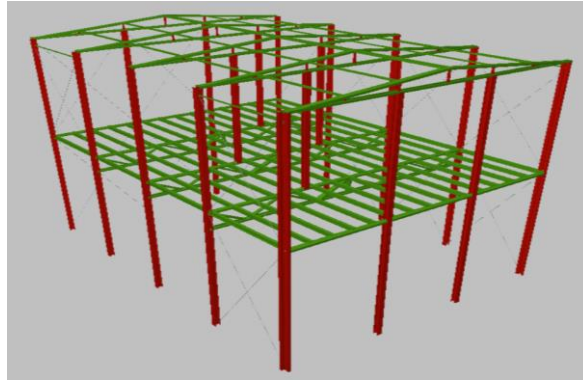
Vivienda 2 plantas, análisis estructural CYPE 2017
